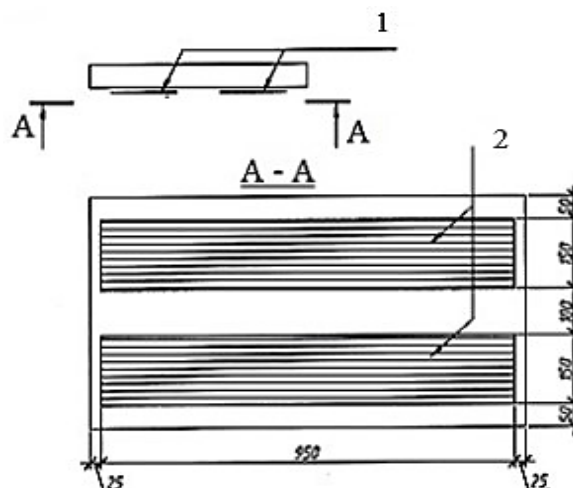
Схема внешнего армирования модельных плит перекрытия с помощью углеродной ленты (1) «CarbonWrap Tape 230/150» (один слой)
